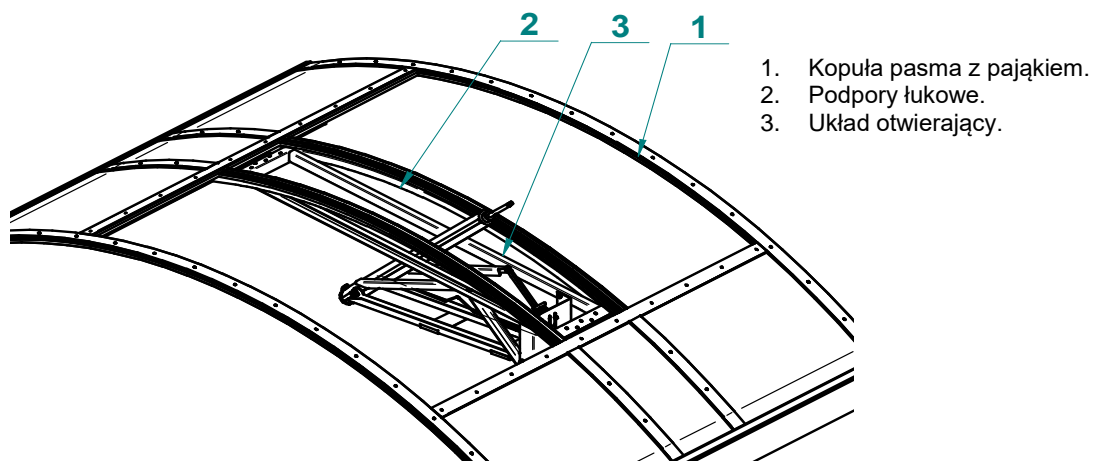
Przykładowe pasmo świetlne przygotowane do montażu klapy
